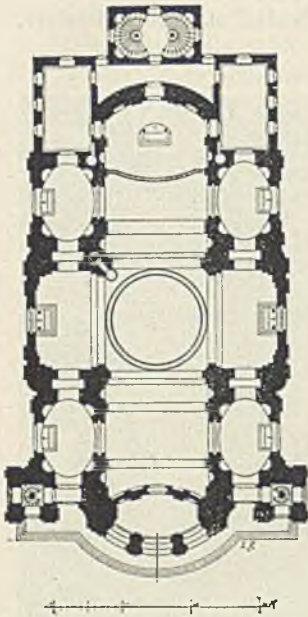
Grundriß der Kollegienkirche zu Salzburg
